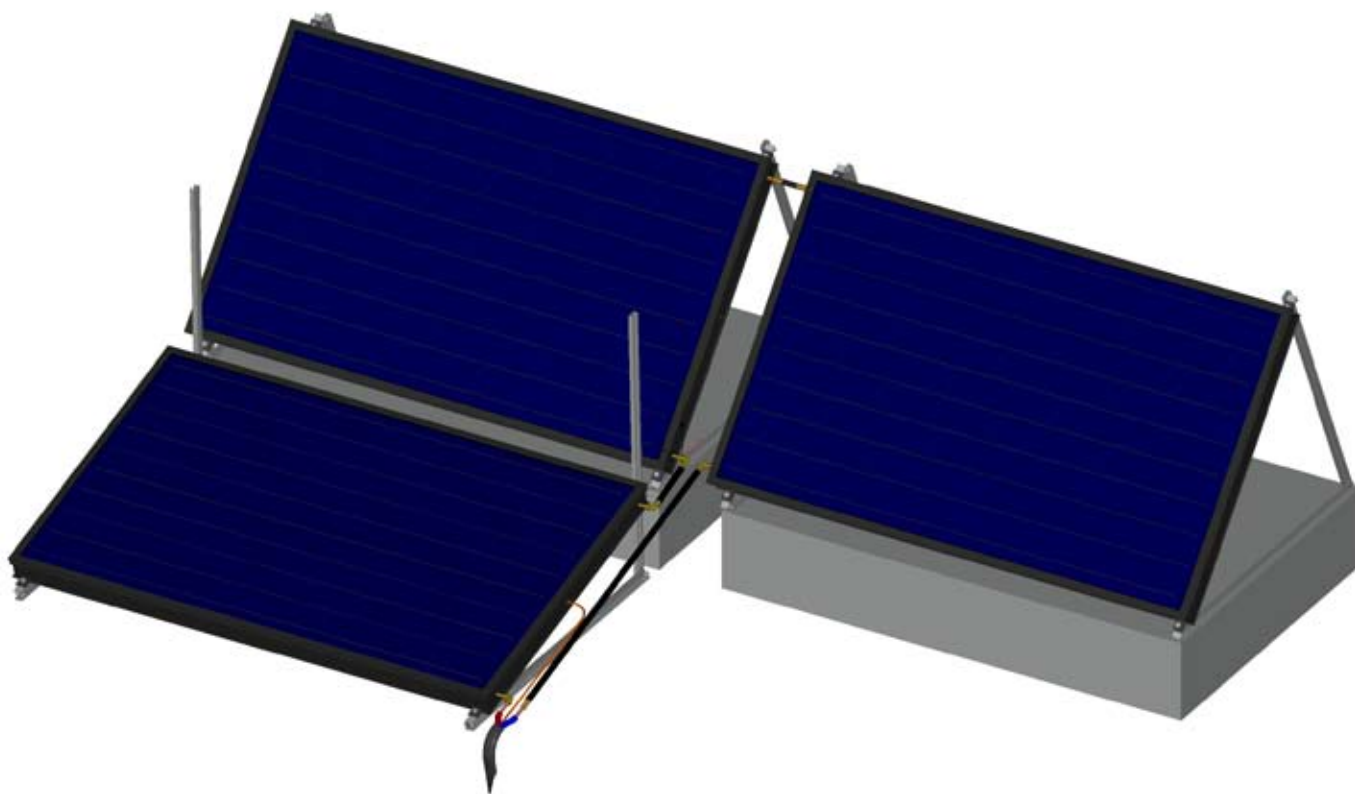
Esempio di configurazione per tre collettori su tetto piano (terzo collettore lato destro inferiore)
